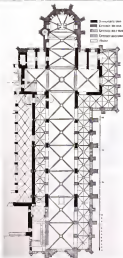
Grundriss der Kirche in Elfenau.
